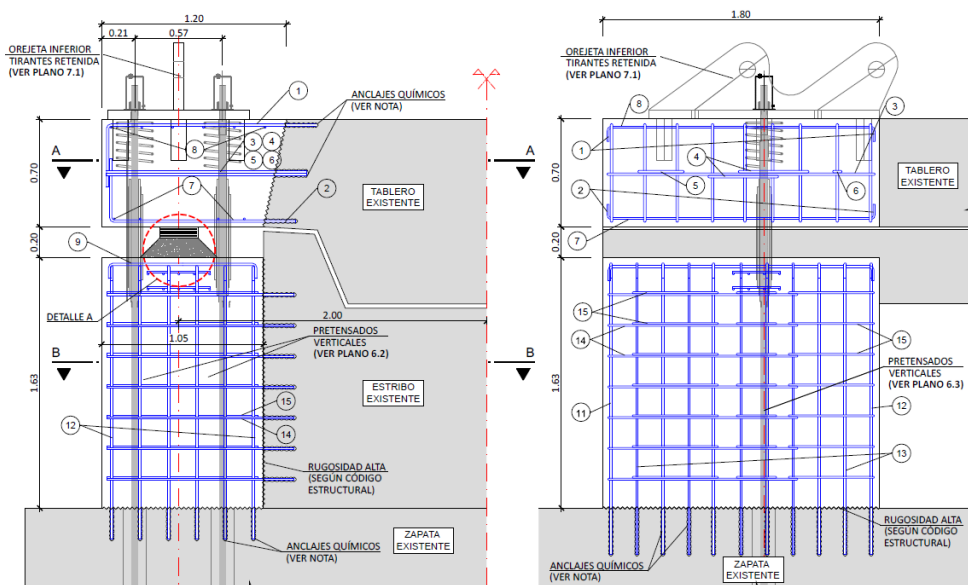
Alzado y sección de recrecidos en estribo E-2.
